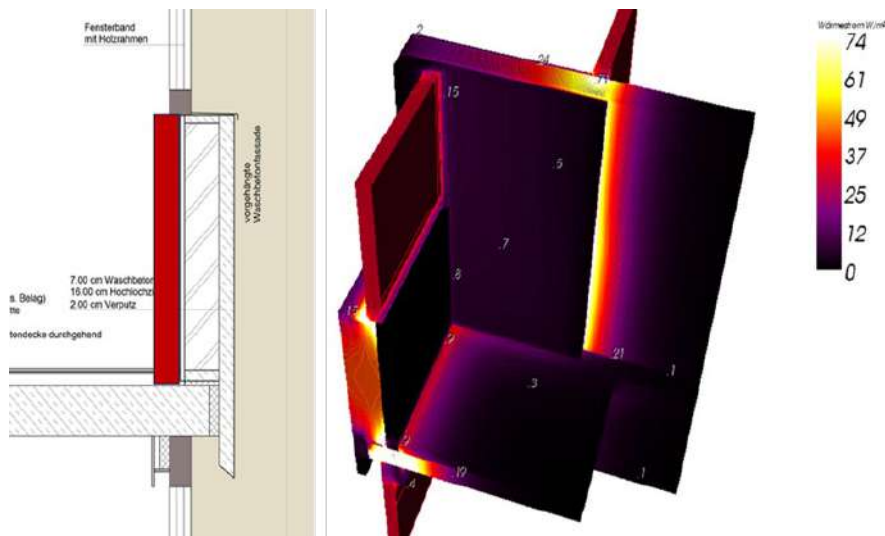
Wärmestrom im Bereich der Stahlbeton-Schotte im ungedämmten Bereich, IBO
